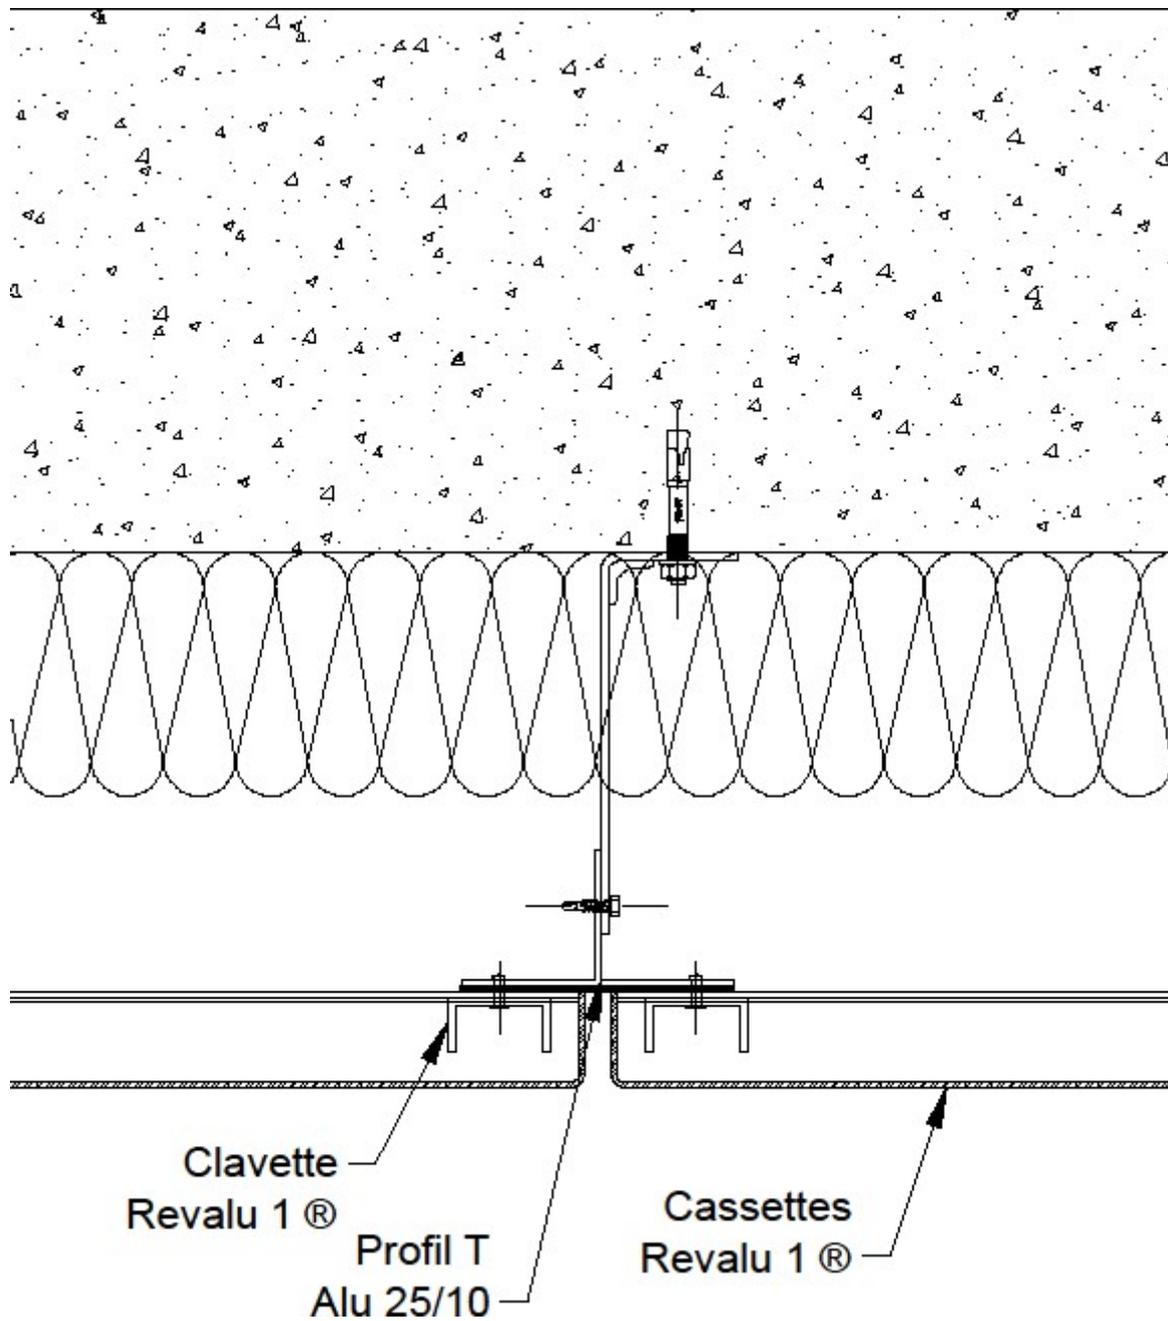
Coupe horizontale au droit du joint sur profilé T
